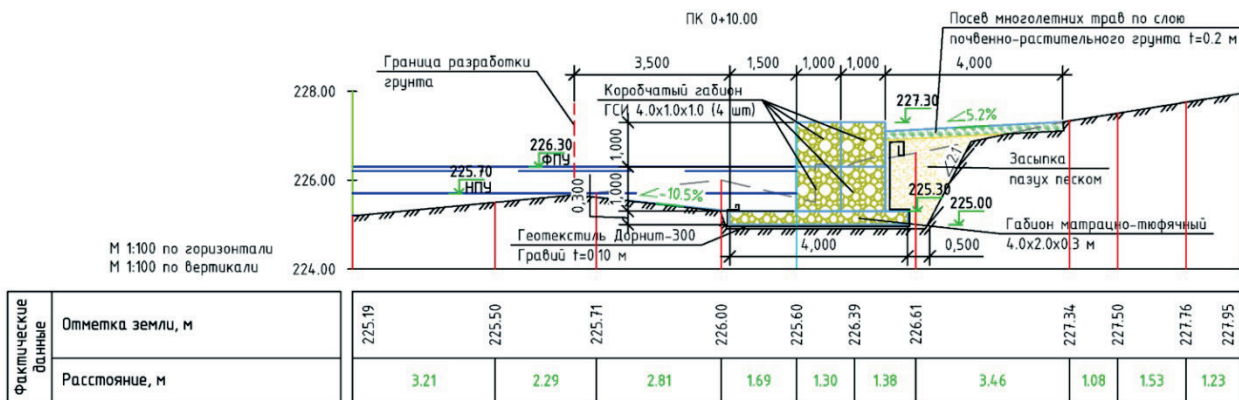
Берегоукрепление габионными конструкциями правого берега в верхнем бьефе водохранилища
